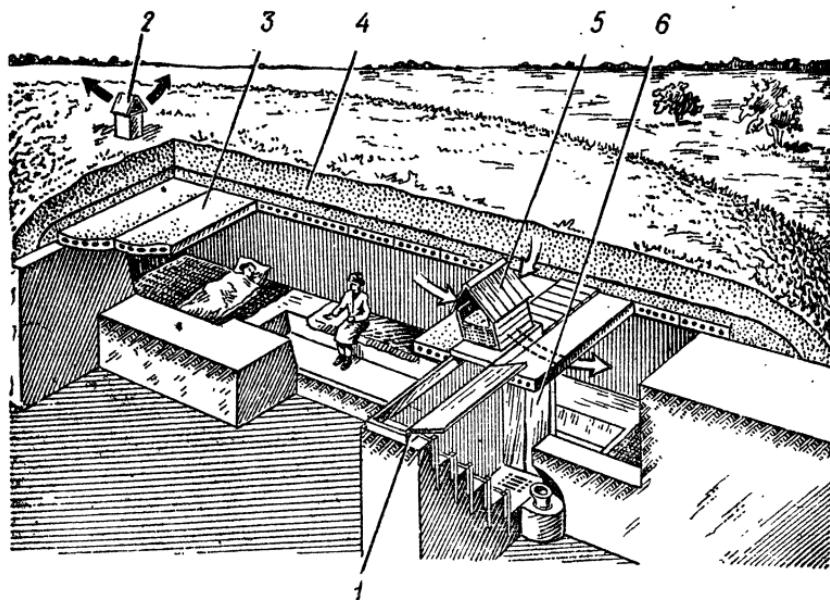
Противорадиационное укрытие с перекрытием из железобетонных плит:
